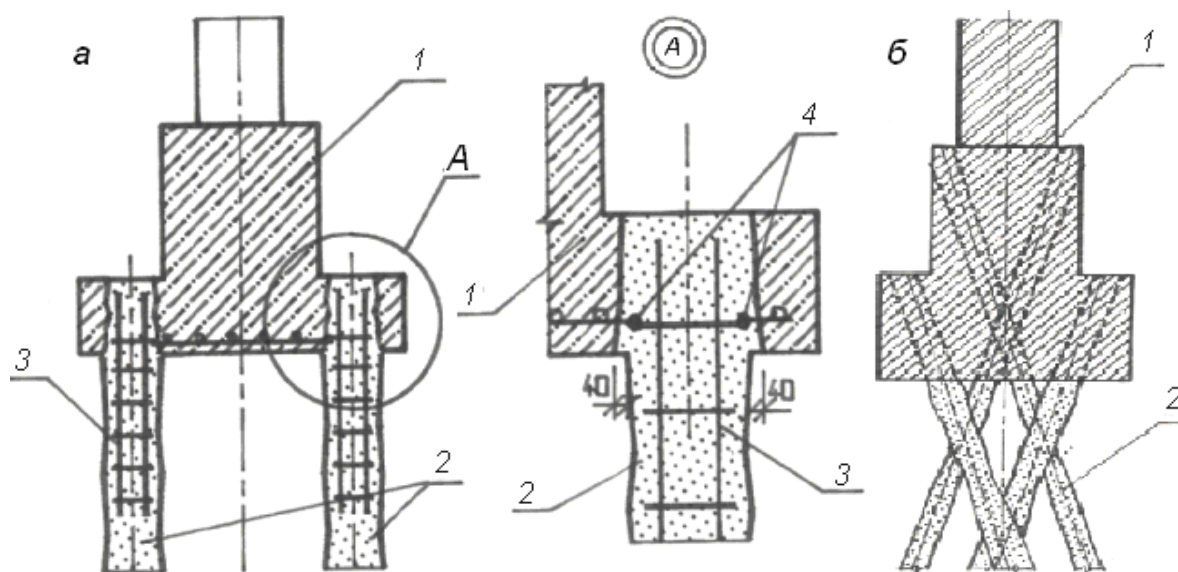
Усиление фундамента сваями: *а* – устраиваемыми под подошвой столбчатого фундамента; *б* – наклонными буронабивными:
